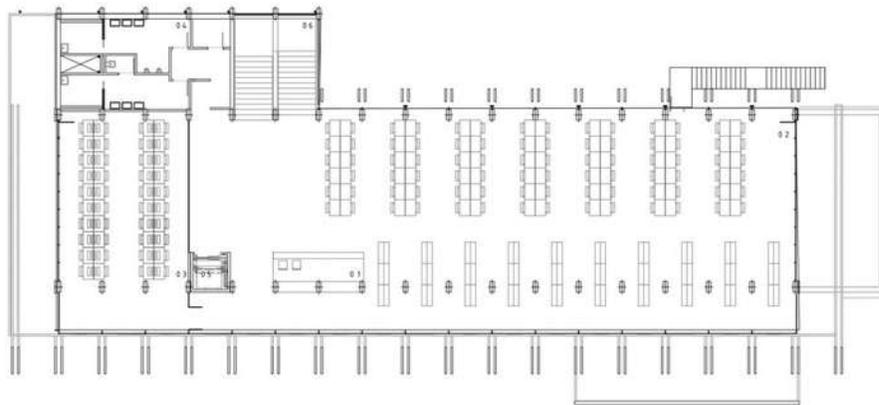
13 Planta Primer Nivel, Biblioteca Comarcal Adolfo Suárez Ronda.
